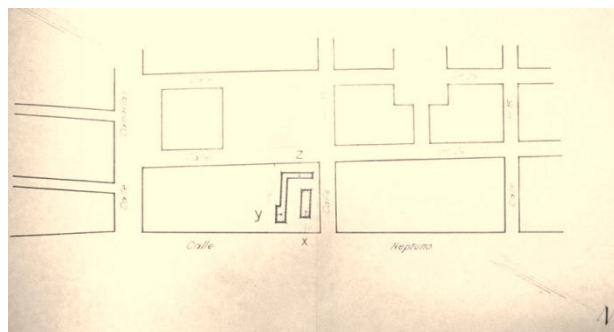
Plano de emplazamiento. Expediente de construcción. AMAG
